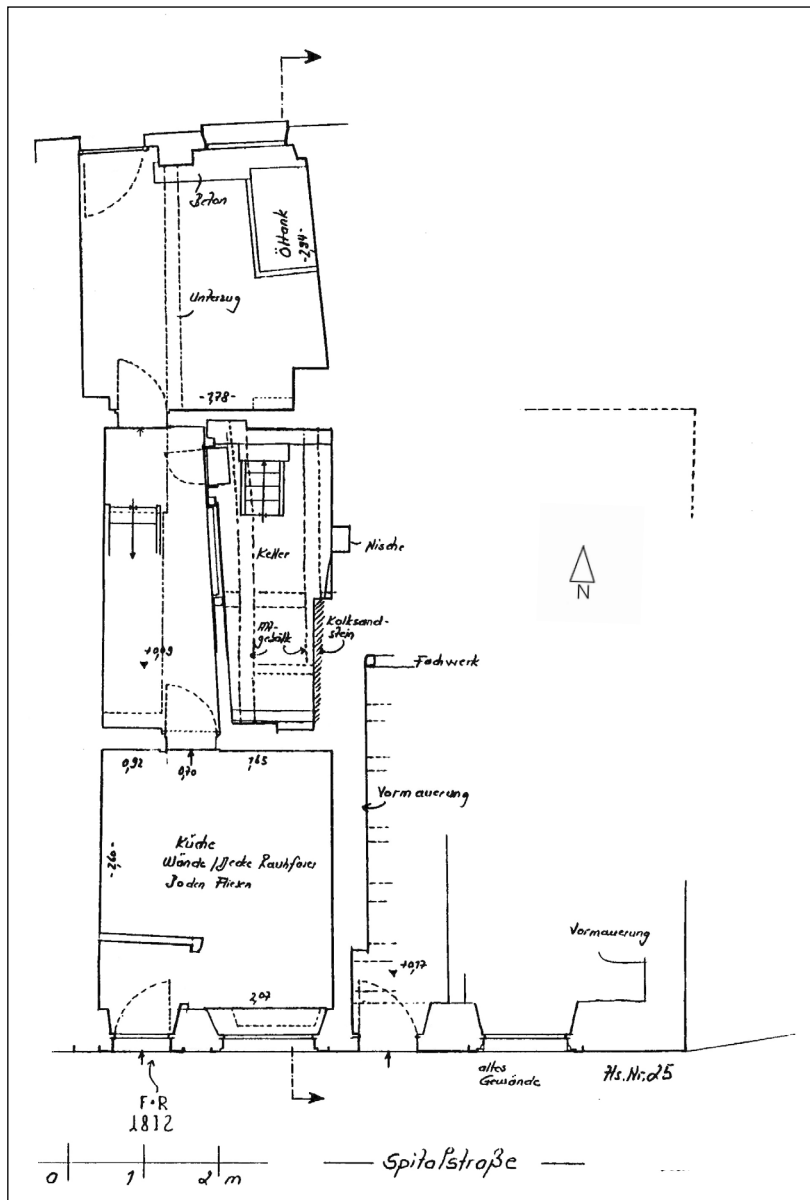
Spitalstraße 23, Grundriss Erdgeschoss.
